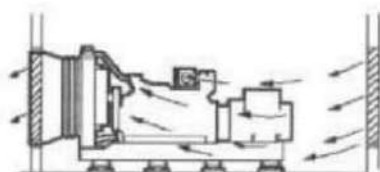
показывает позицию ДГУ наиболее подходящую по отношению к стенам здания. Площадь свободного потока отделов вентиляции выхода и воздуха между стенами должна быть больше на 25%, чем фронтальная площадь панели радиатора и должна иметь такую же прямоугольную форму.
